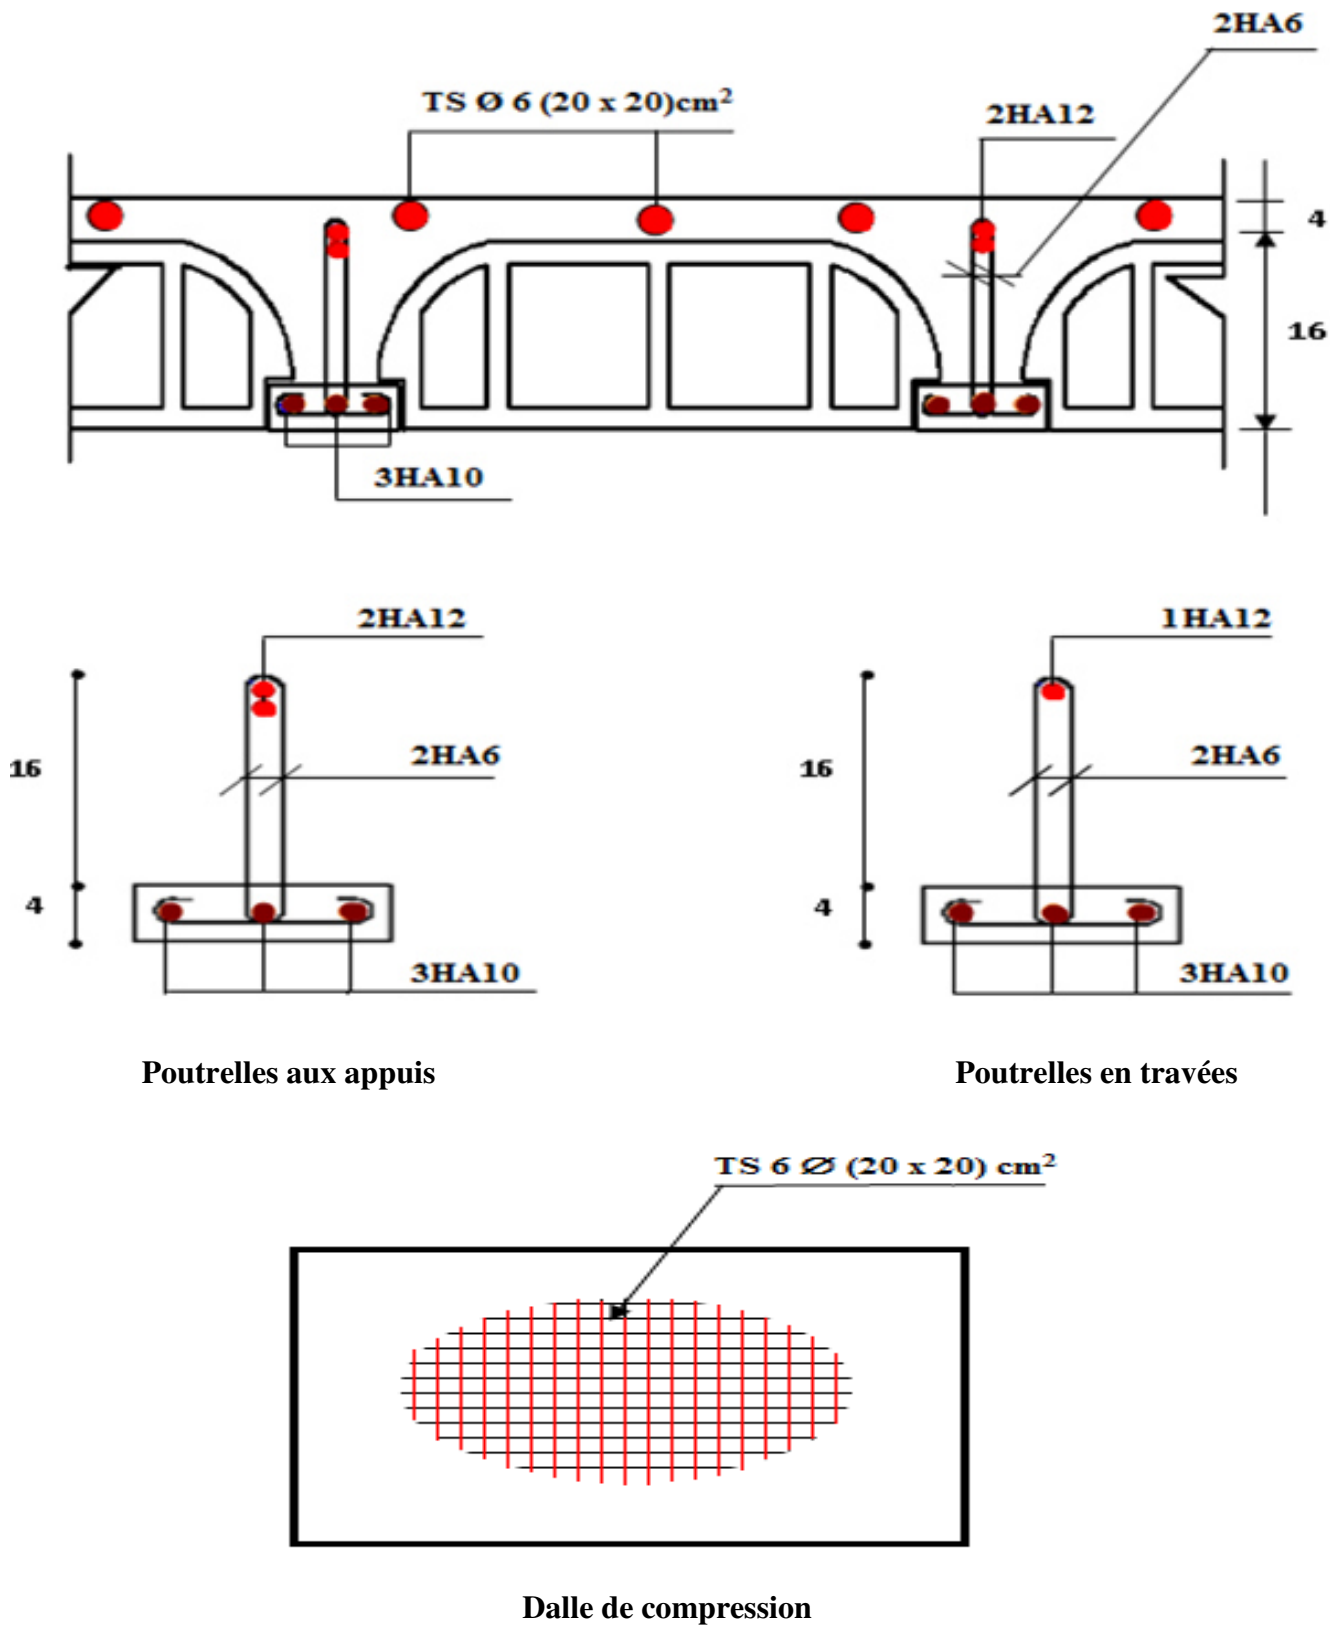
Schéma de ferraillage du plancher à corps creux.
